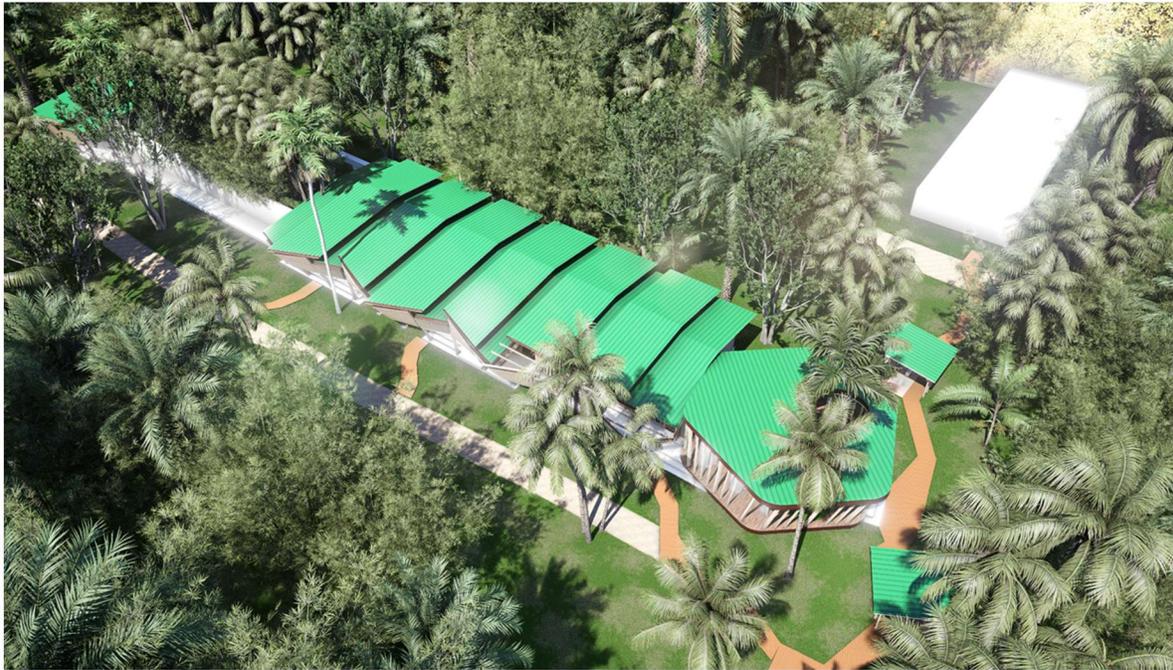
y 14. Planta de localización futura intervención. Fuente: GI PNNC
